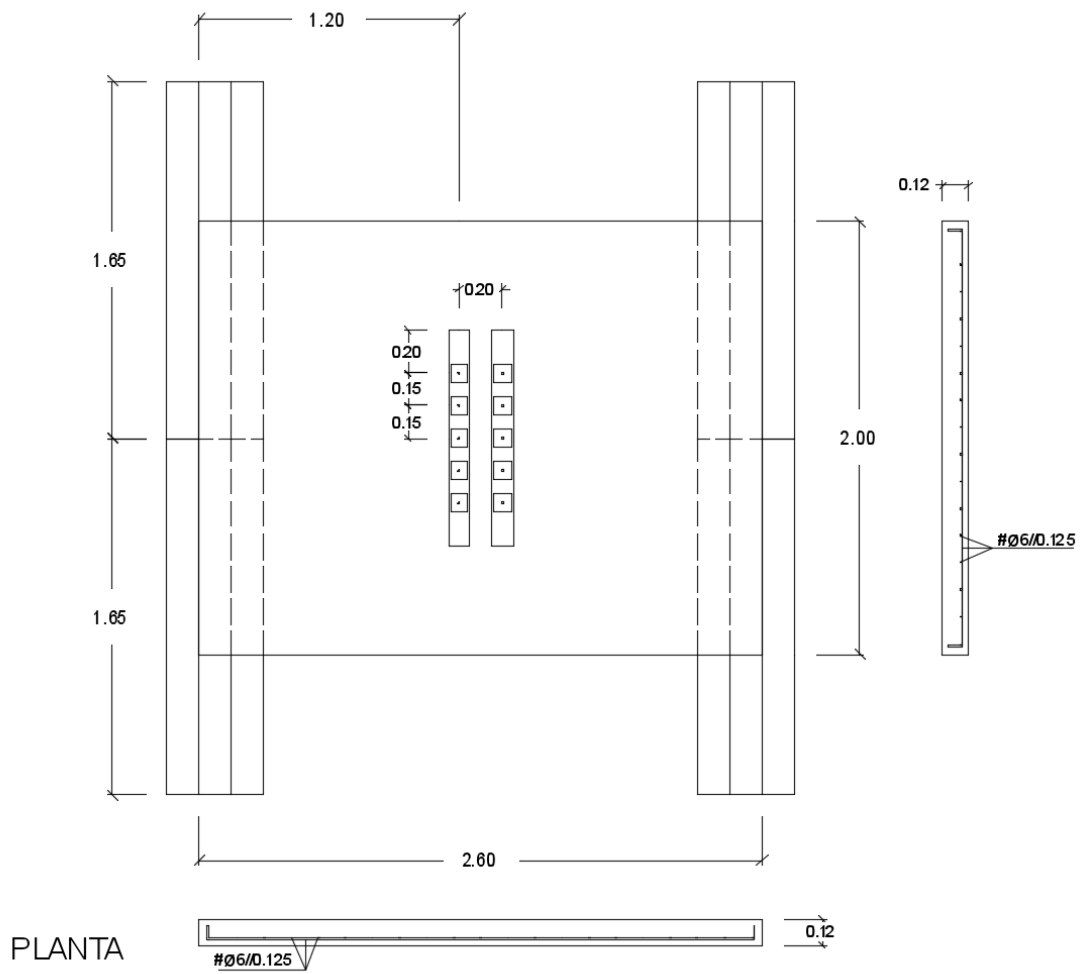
Planta do esquema de ensaio com localização das hastes metálicas
